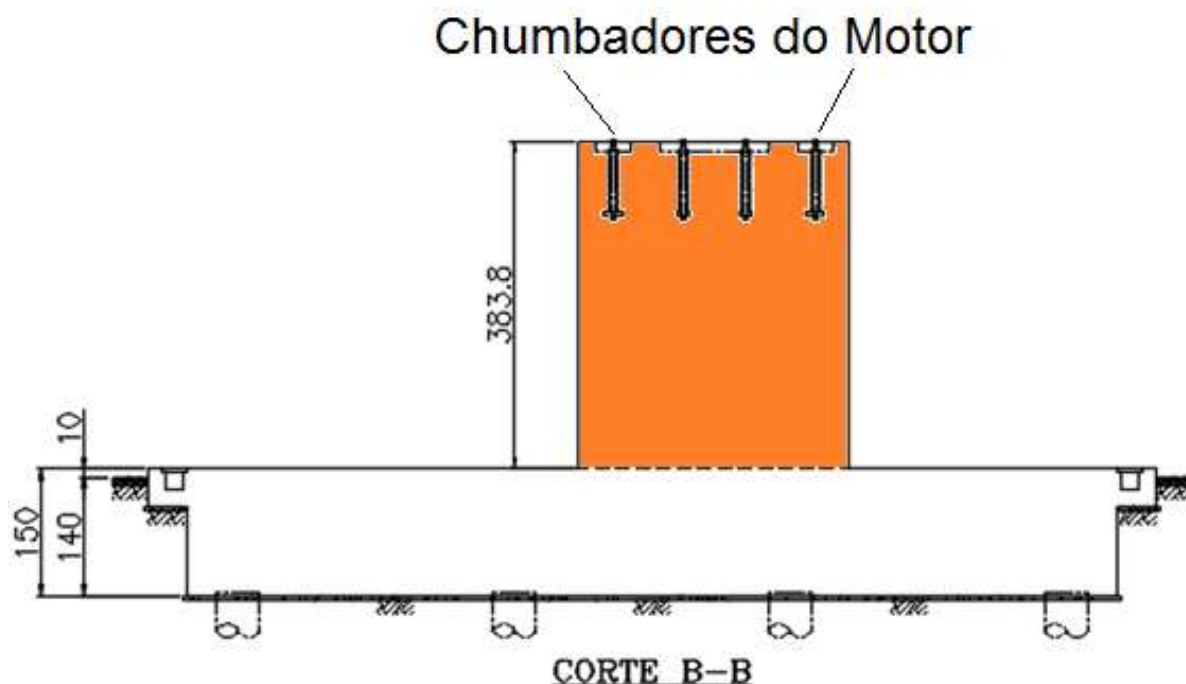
Modelo estrutural: elevação da fundação (Corte B-B) [3].
